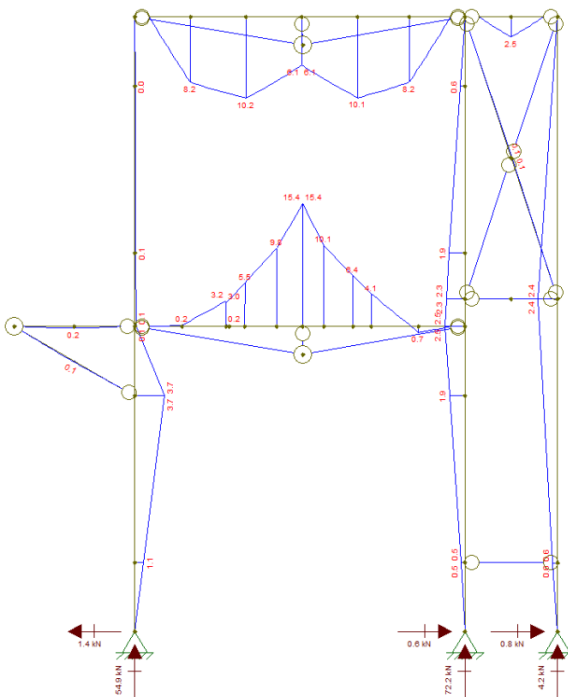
Análise estrutural do pórtico P4 P5 P6 com vento oeste com alterações da Opção 04
